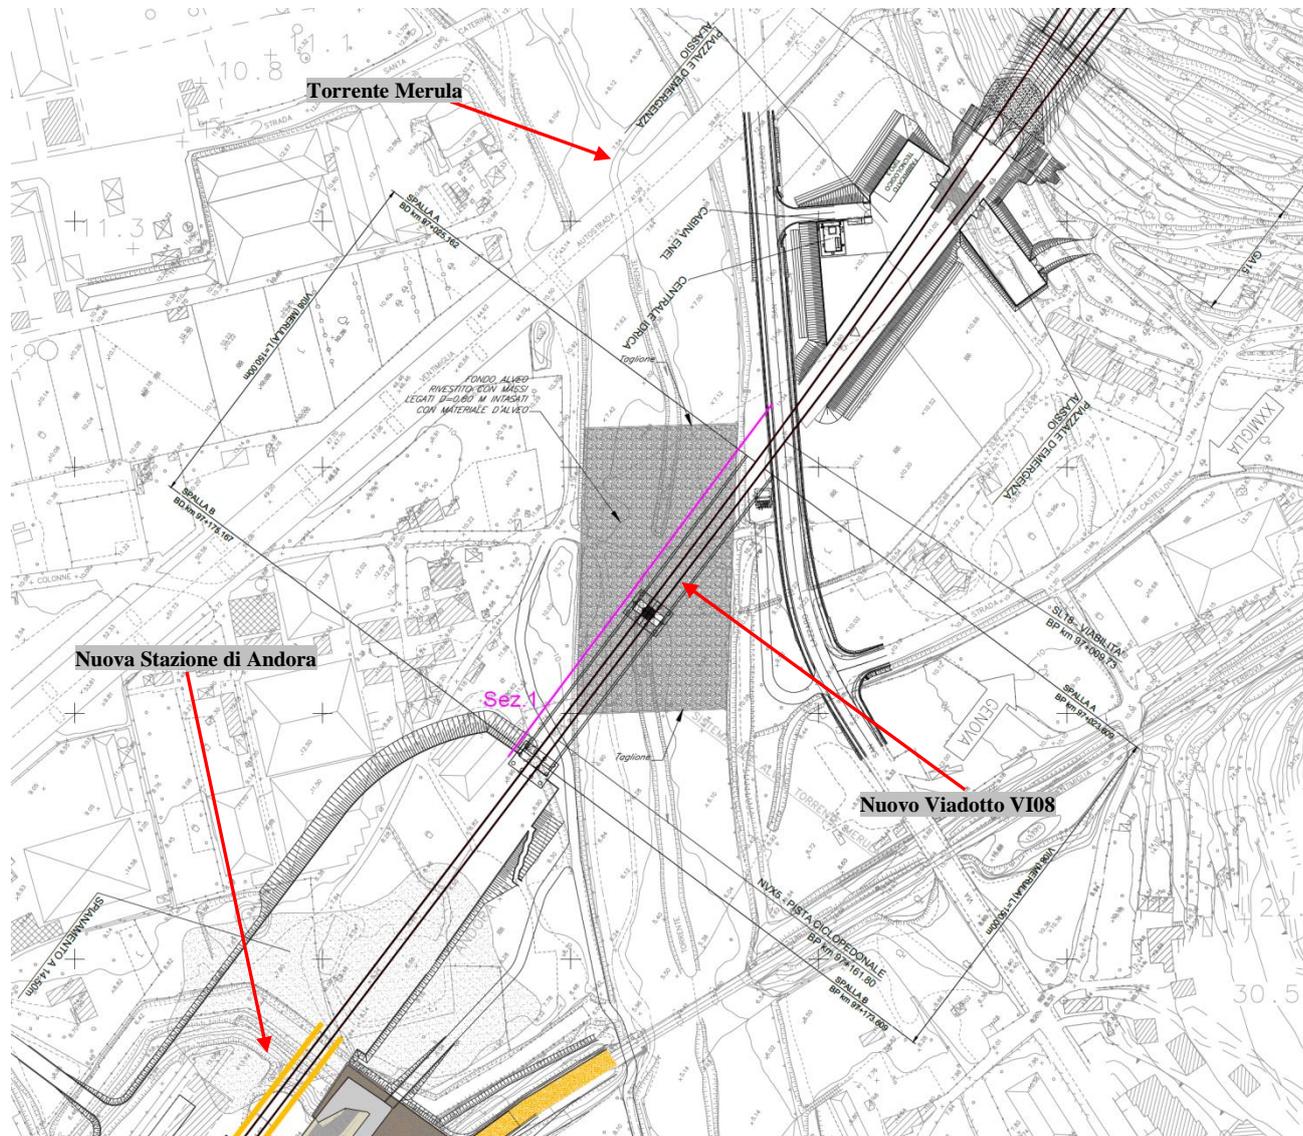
Stralcio della planimetria di progetto in quel di Andora.
